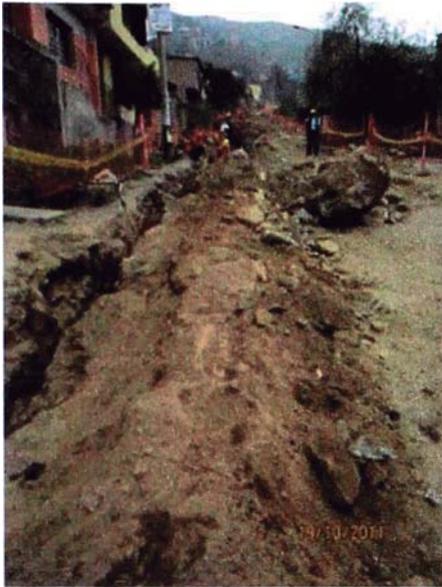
Vía sin pavimento donde se profundiza la red de gas.
